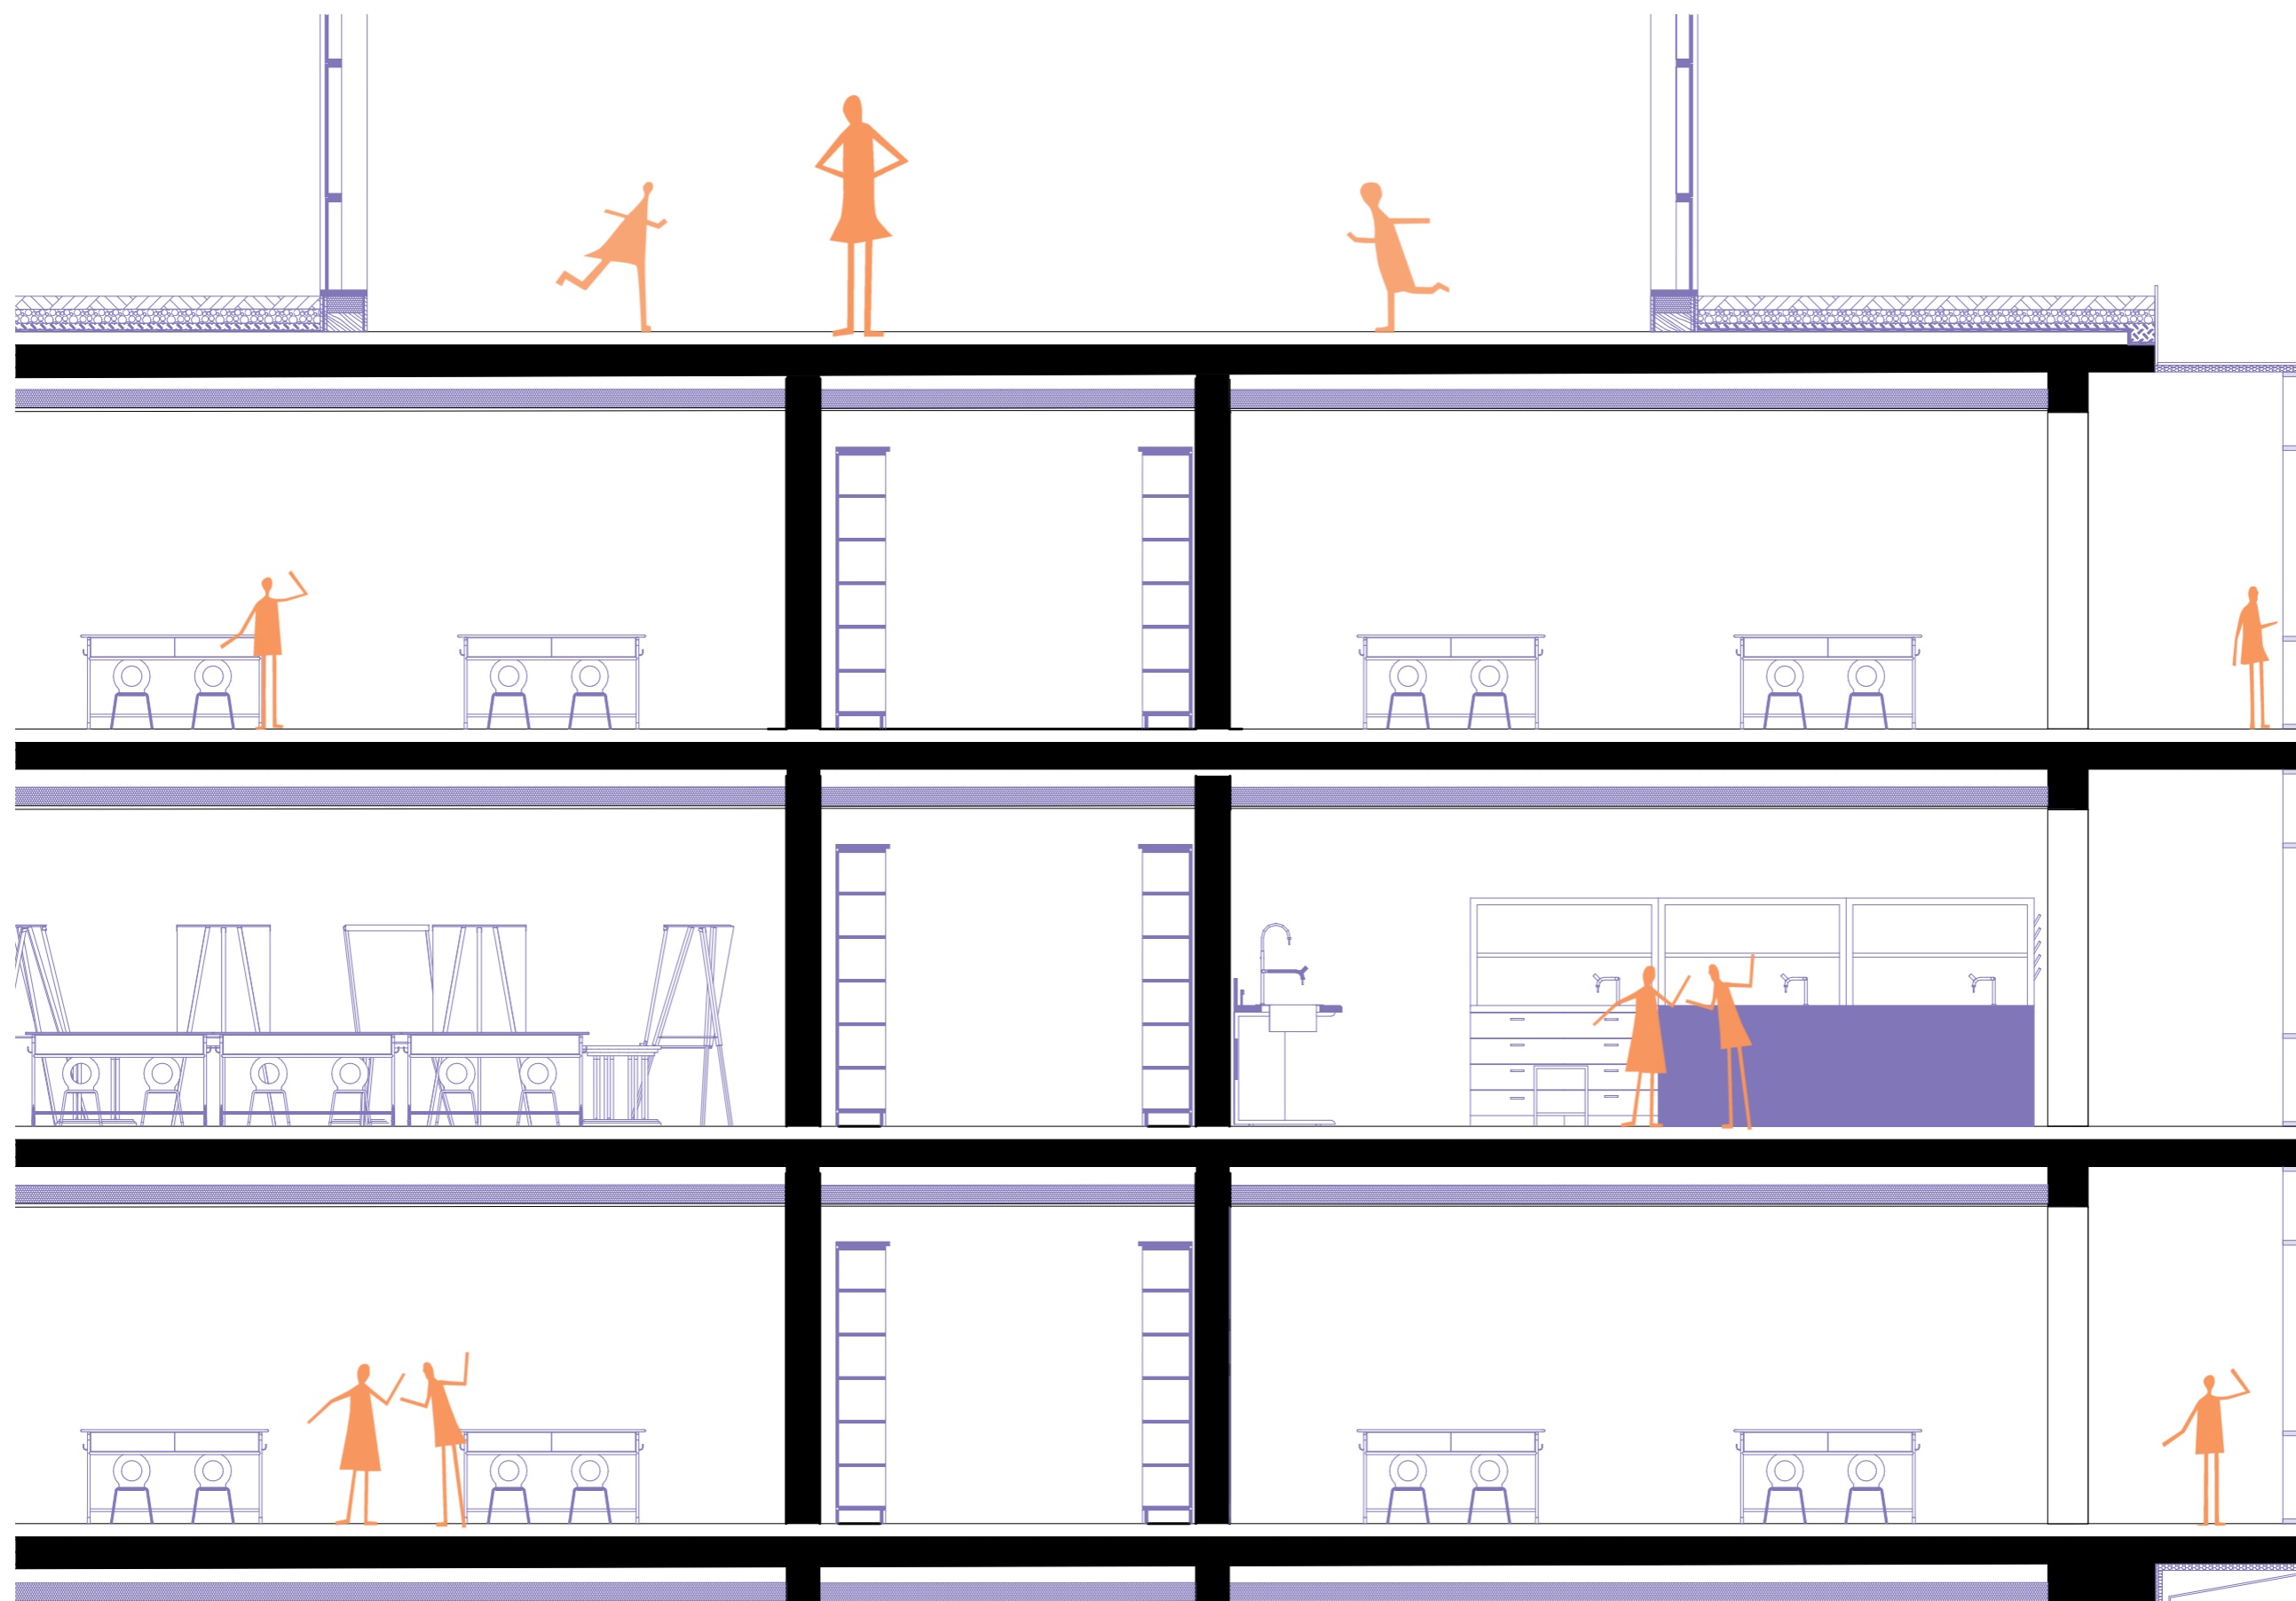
Coupe bâtiment rue Breydel (réalisée par l'autrice, 2025)
